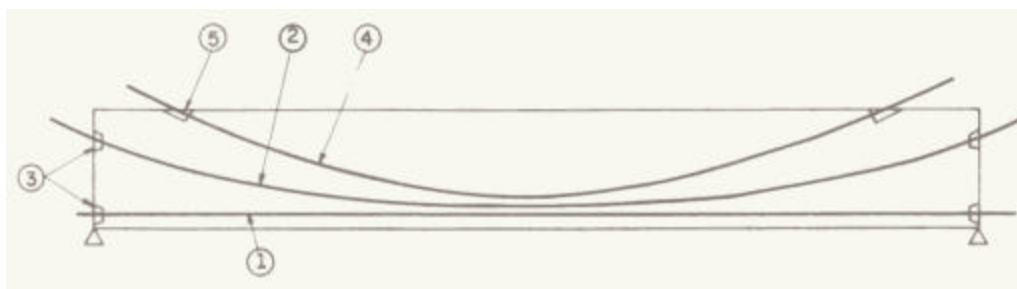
Cabos de protensão usuais em vigas simplesmente apoiadas
